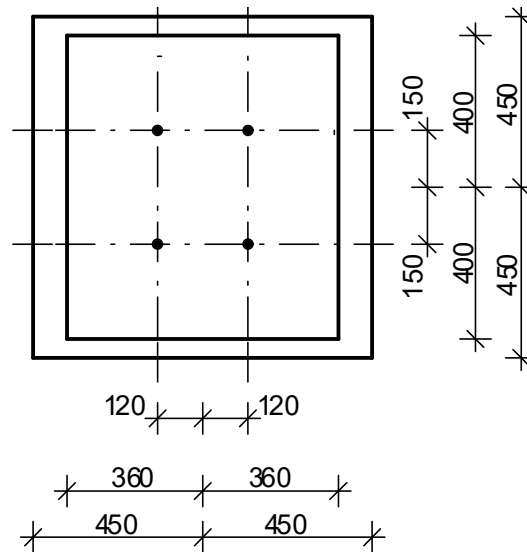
Схема верху підколонника з розміщенням бази колони
